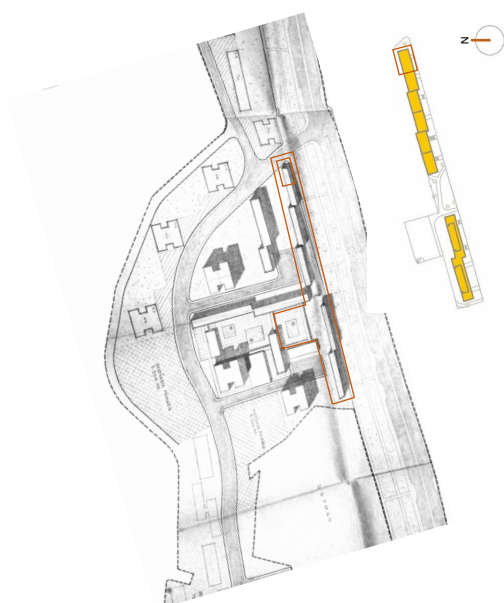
Plano de situación original, en planta, del edificio ubicado en la Avenida Castelaο-Coia, 30. Se complementa con una imagen de la vista en planta de la parcela en la que se sitúa el presente edificio (fotografía de autoría propia).
